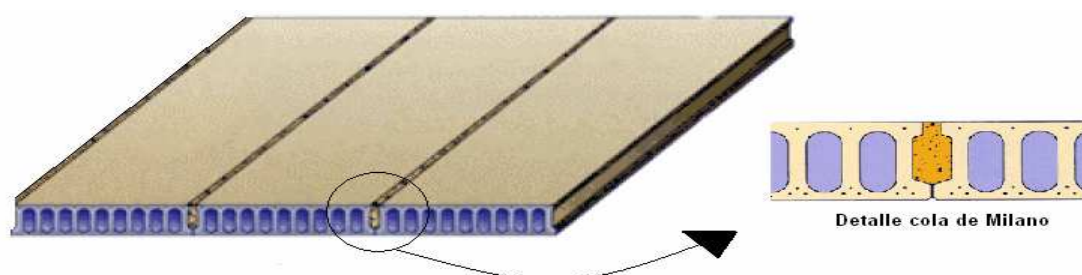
Detalle perfil longitudinal placa alveolar.
